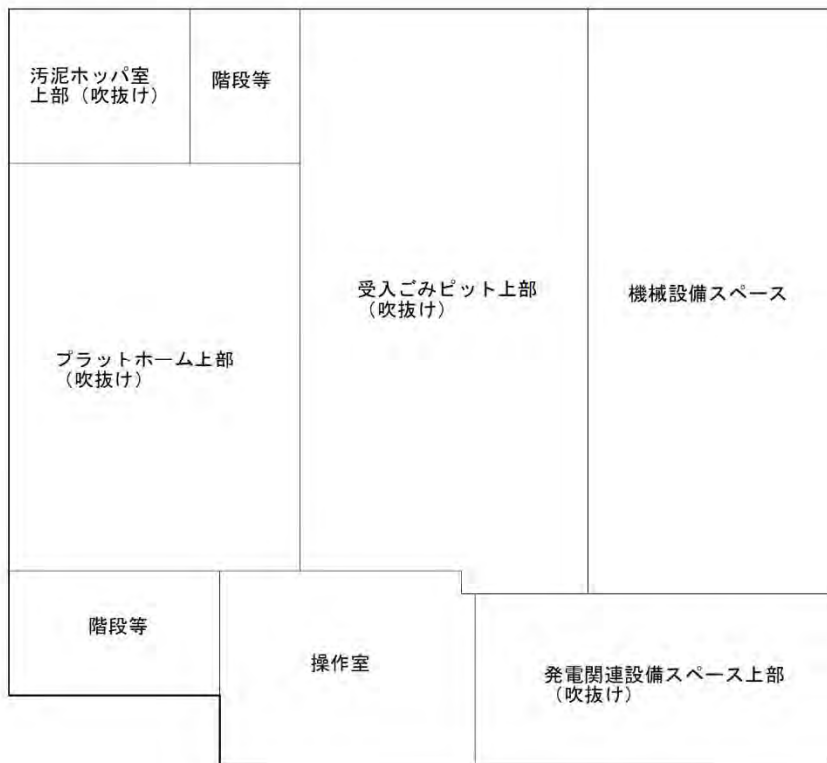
(4) 廃棄物受入棟平面図 (3 階)
